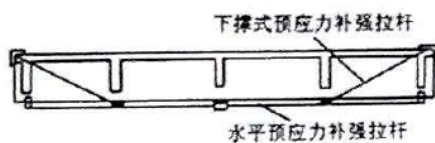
组合式预应力补强拉杆加固钢筋混凝土梁
